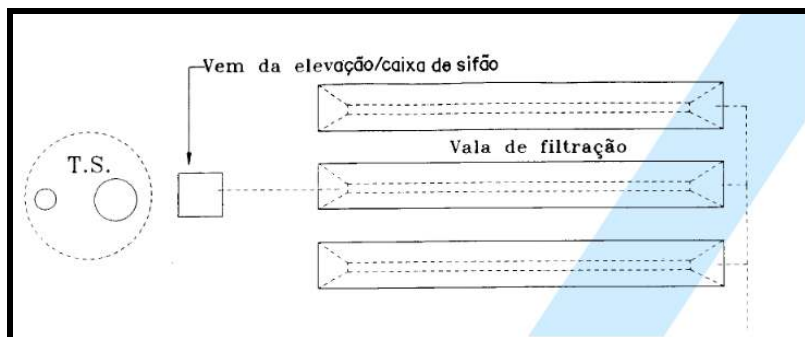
Planta de vala de filtração típica (NBR 13969, 1997)
